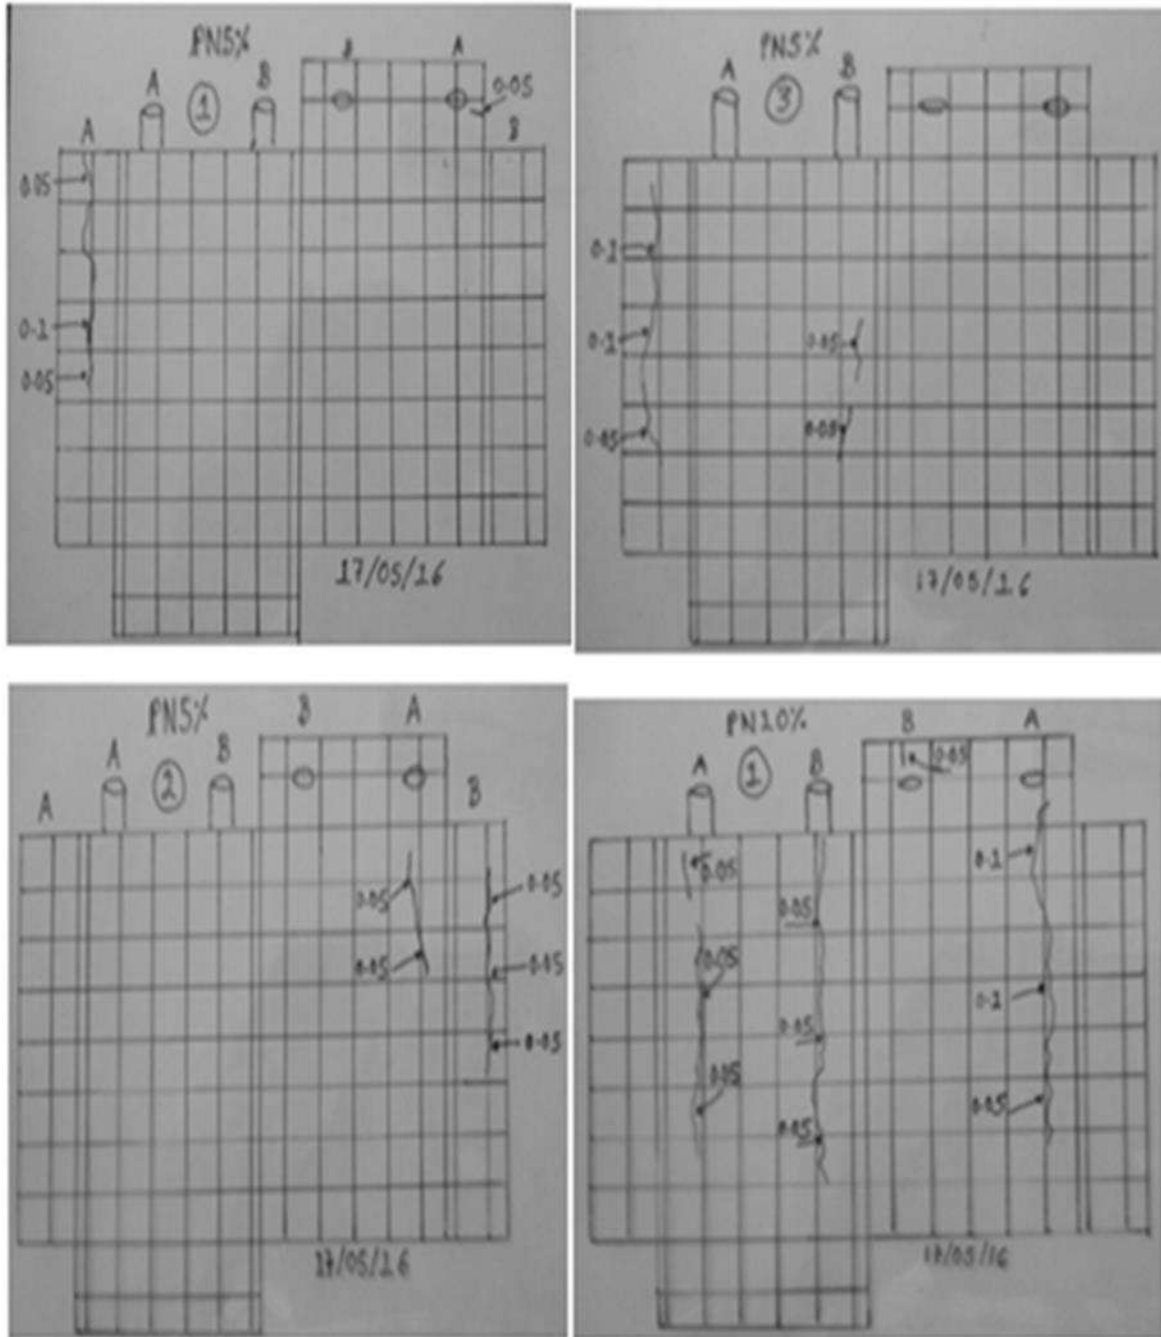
Levantamiento de grietas en PN5% en probetas 1, 2 y 3, PN10% en probeta 1. Fuente: (T. Francisco. Martínez)
